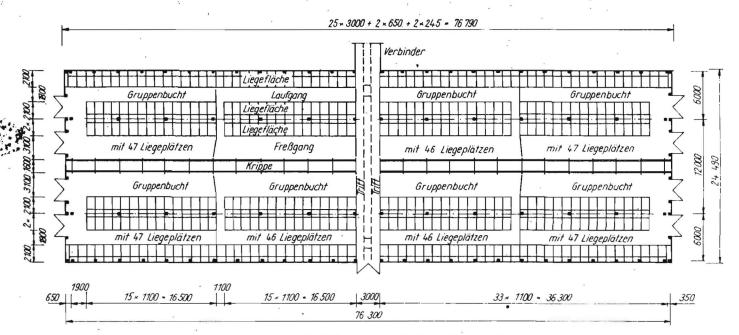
Bild I. Grundriß des Angebotsprojekts "Produktionsstall für 400 Milchkühe"; Systemmaße 24 m × 75 m, stationäre Fütterung
